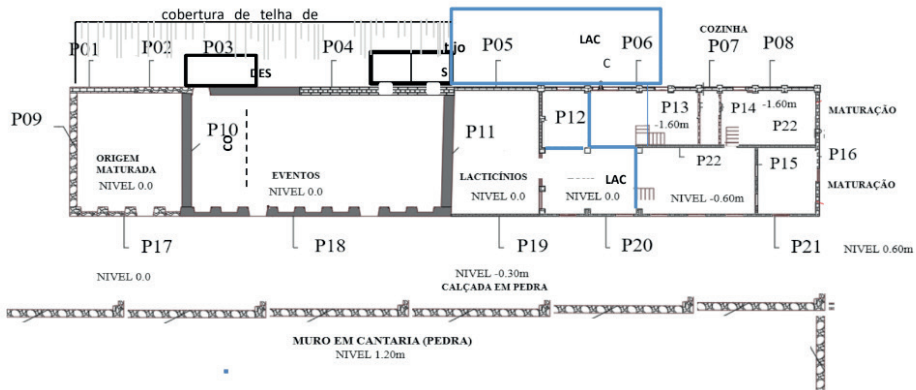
Planta baixa da Tulha, com as atuais atividades e a sinalização das diversas técnicas construtivas encontradas pelo restaurador Prof. Tognon. (Fonte: Próprio Autor, 2022).
